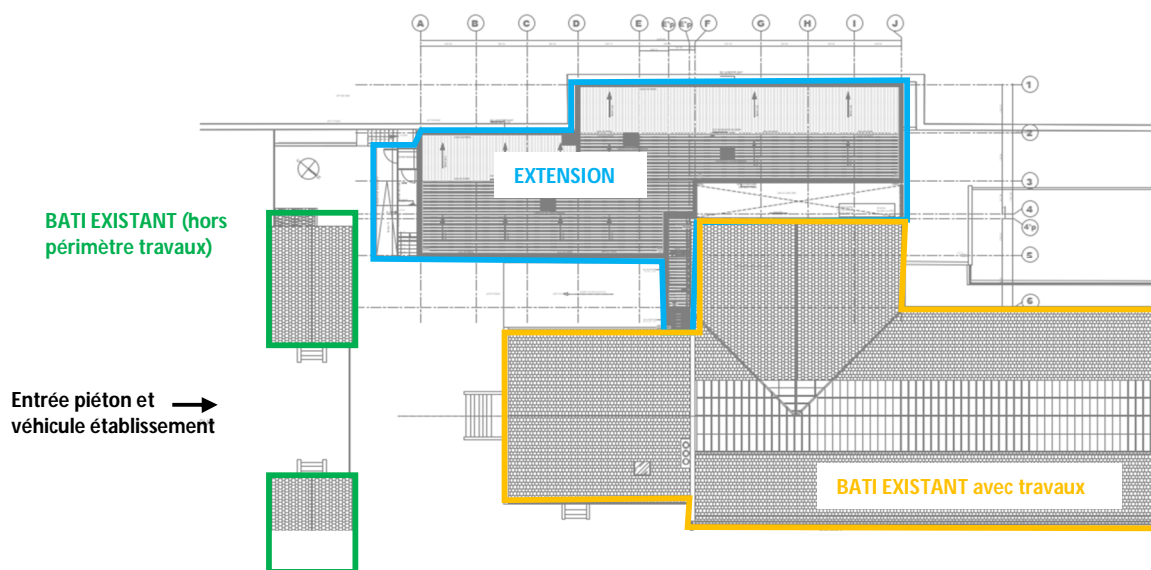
Maison d'arrêt de TULLE - Extrait plan toiture
